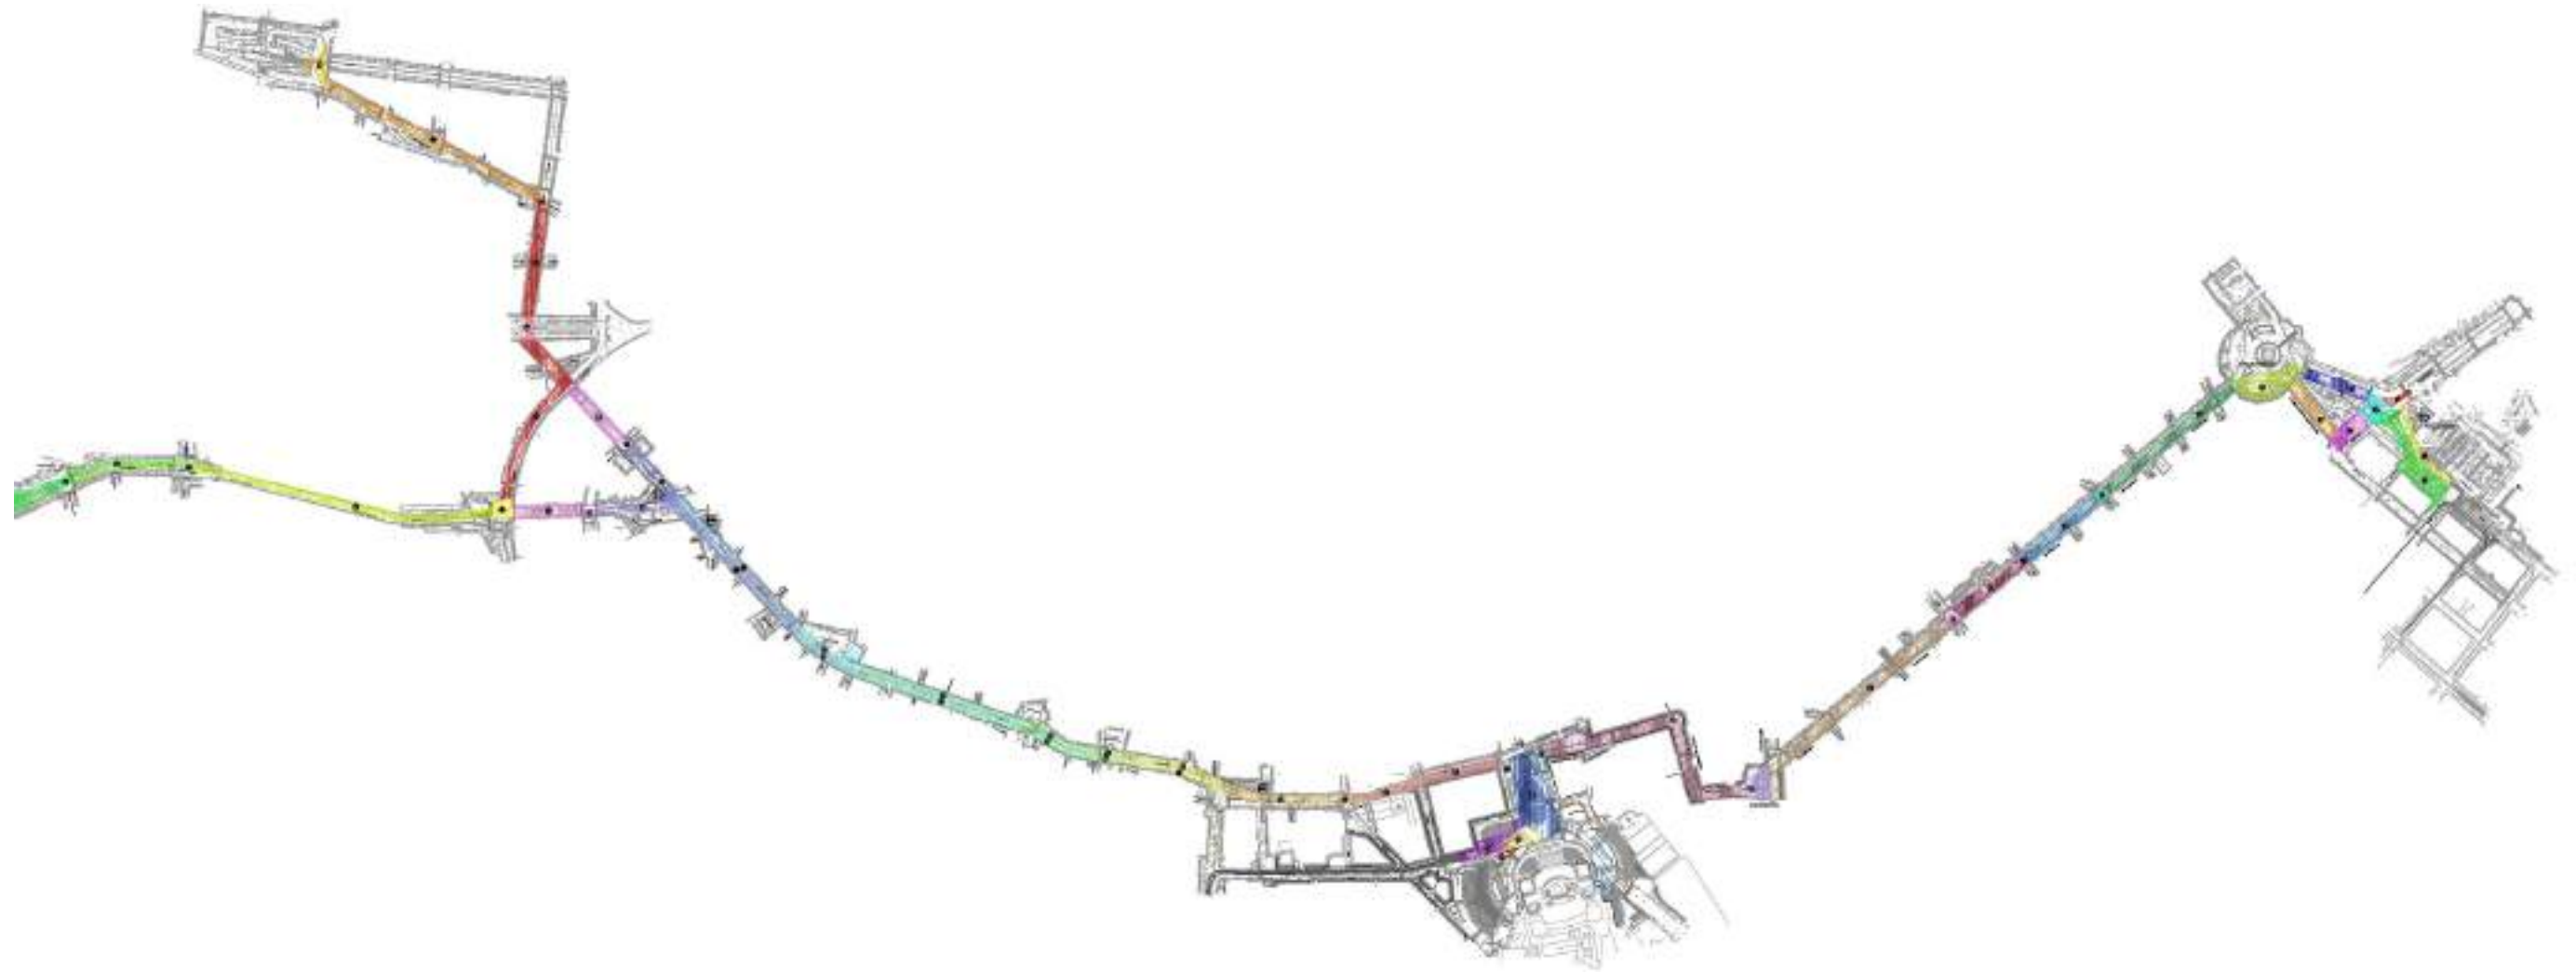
Planimetria generale aree di cantiere 1 di 2
